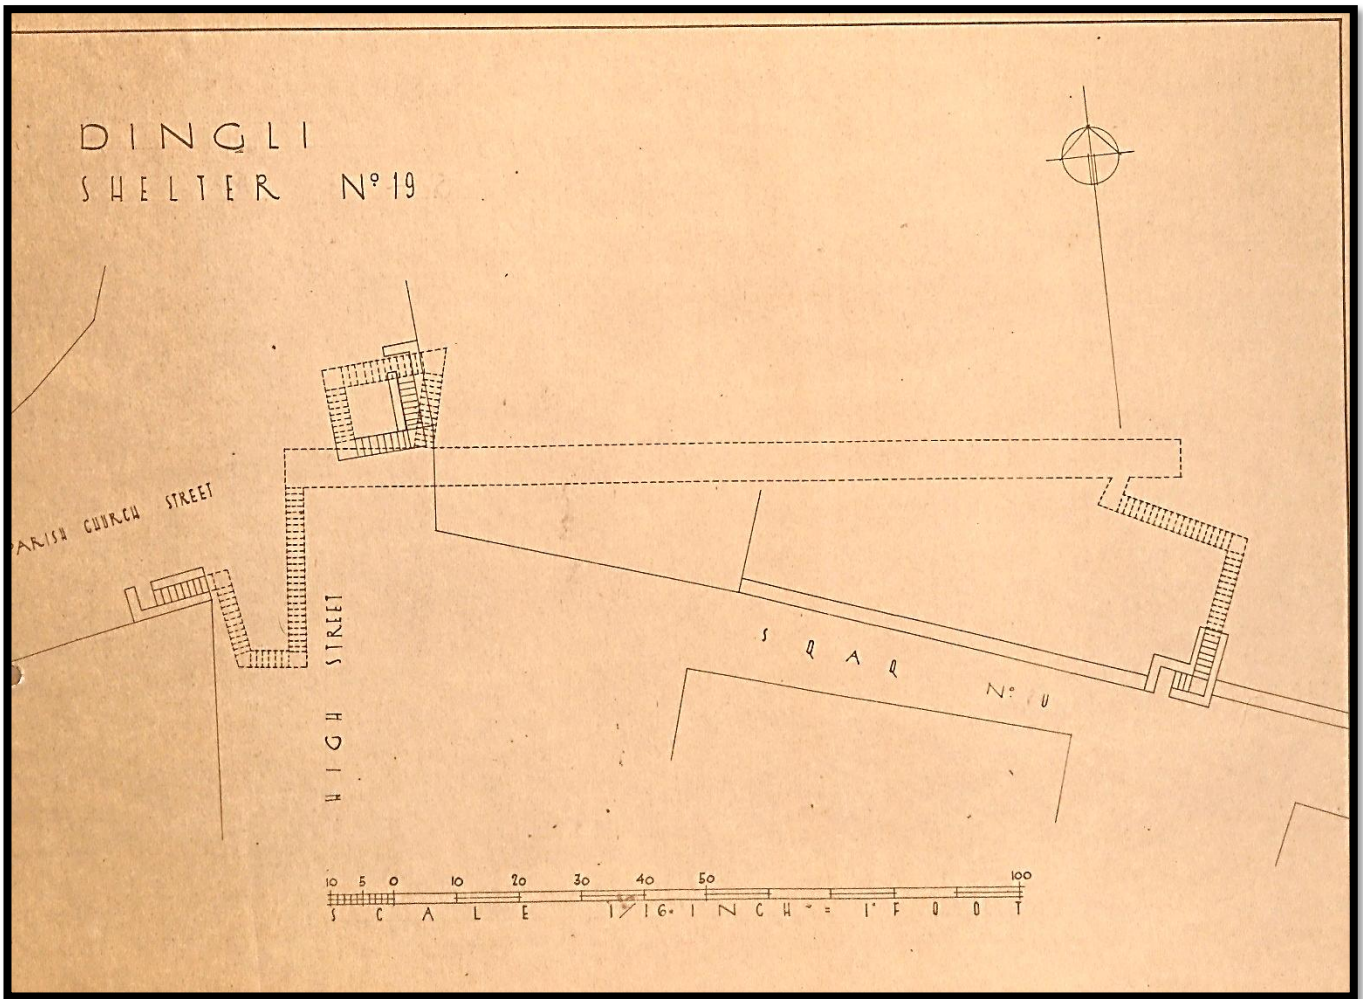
Planta do Abrigo nº 19 (2) "High Street – Parish Church Street."
